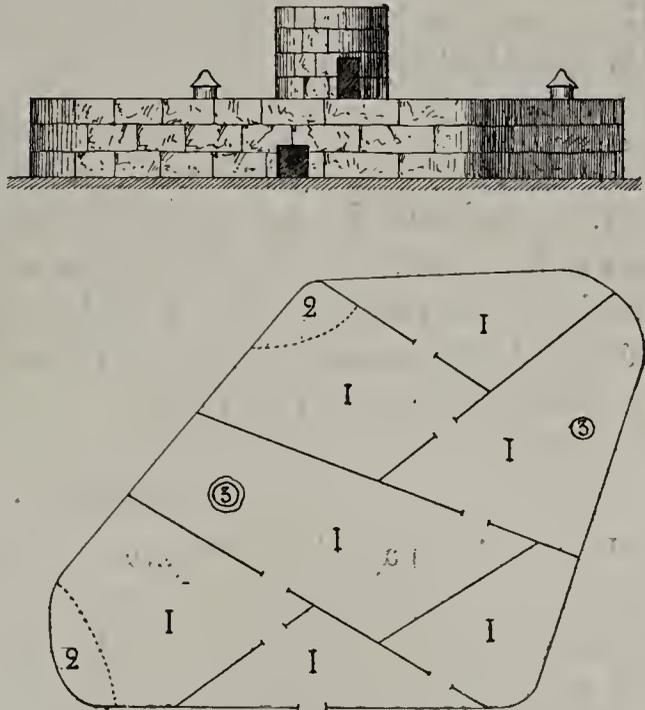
Élévation et plan d'une soukhala dagari, à l'échelle de 1/250.
